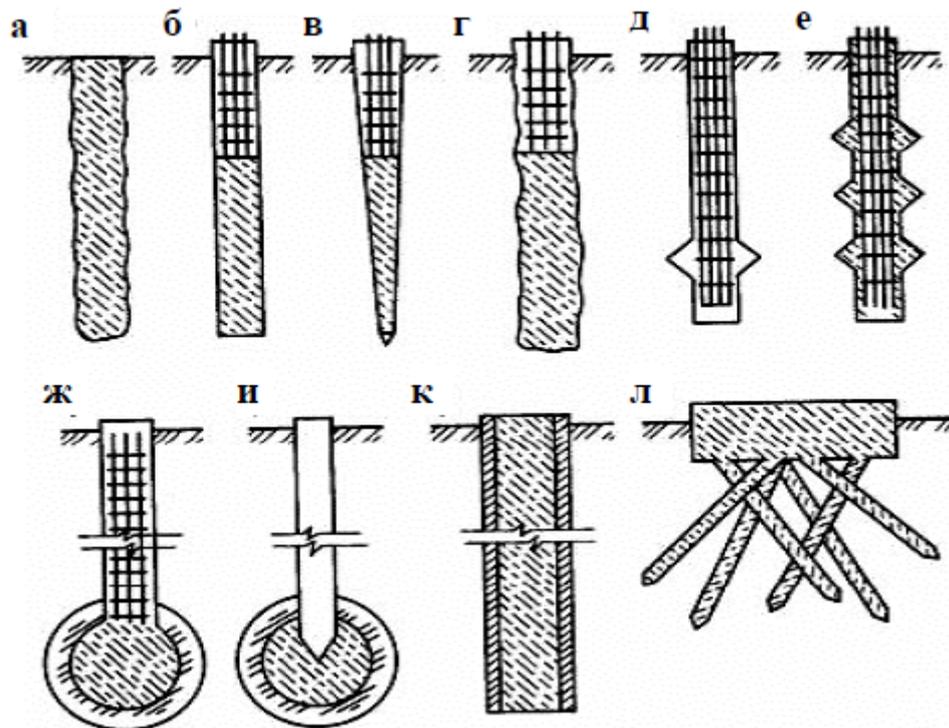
Набивні палі: а – бетонна; б – залізобетонна циліндрична; в – конічна; г – із профільованою поверхнею; д – з одним розширенням; е – з декількома розширеннями; ж – із камуфлетним розширенням; и – комбінована камуфлетна; к – в залізобетонній оболонці; л – коренеподібні палі
